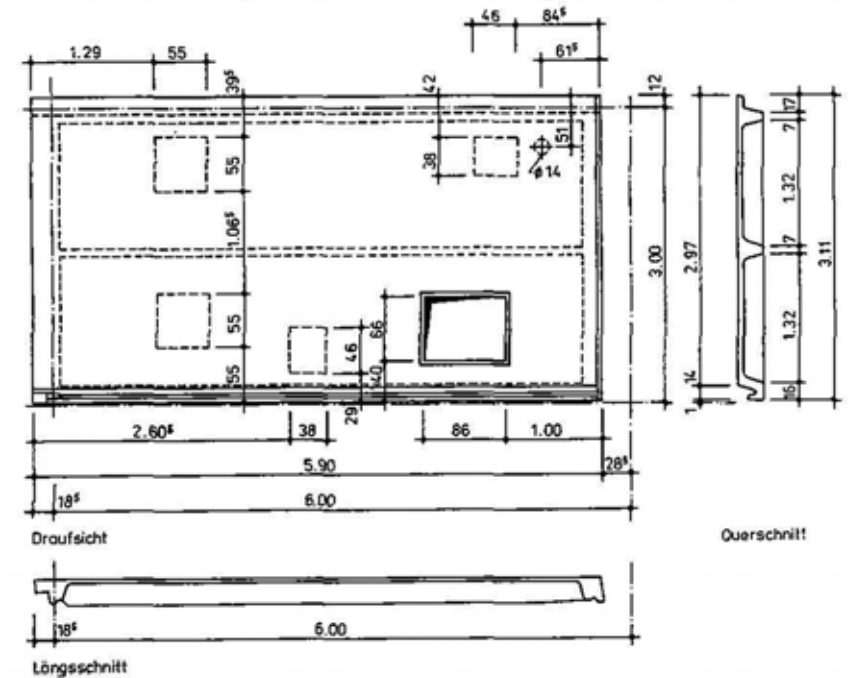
Dachkassettenplatte mit Öffnungen
